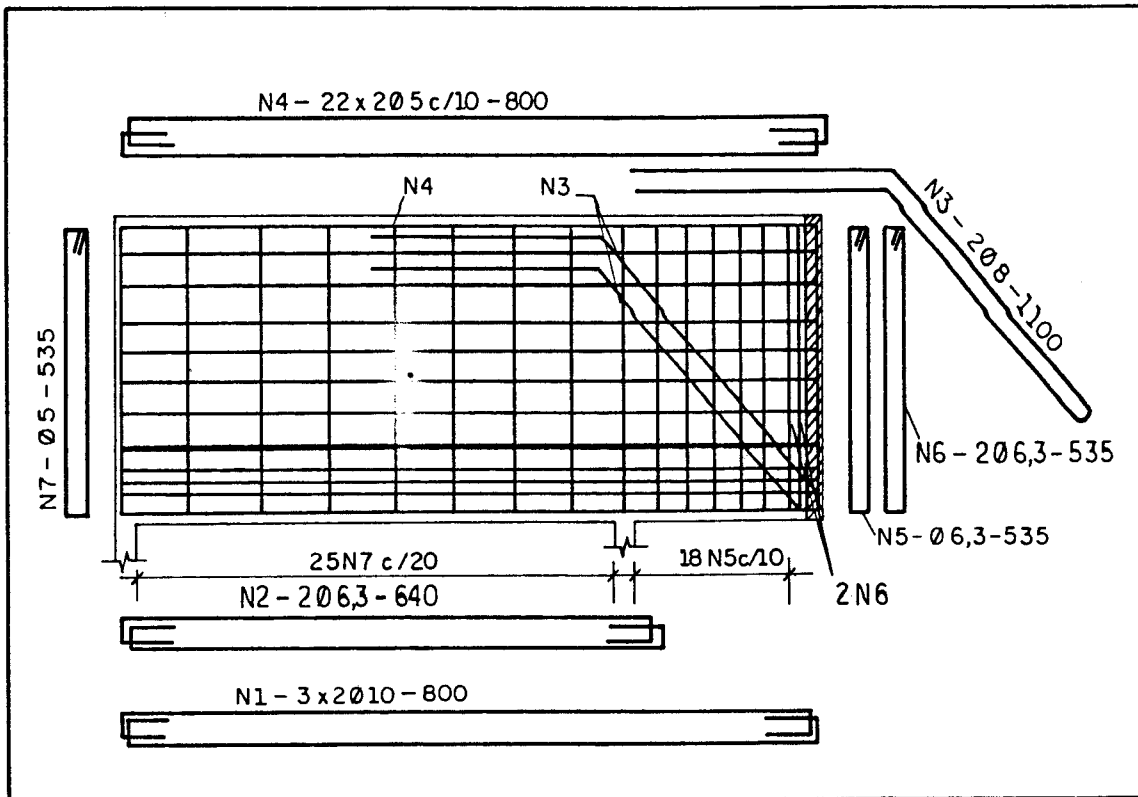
Detalhamento da viga-parede do exemplo 6.
